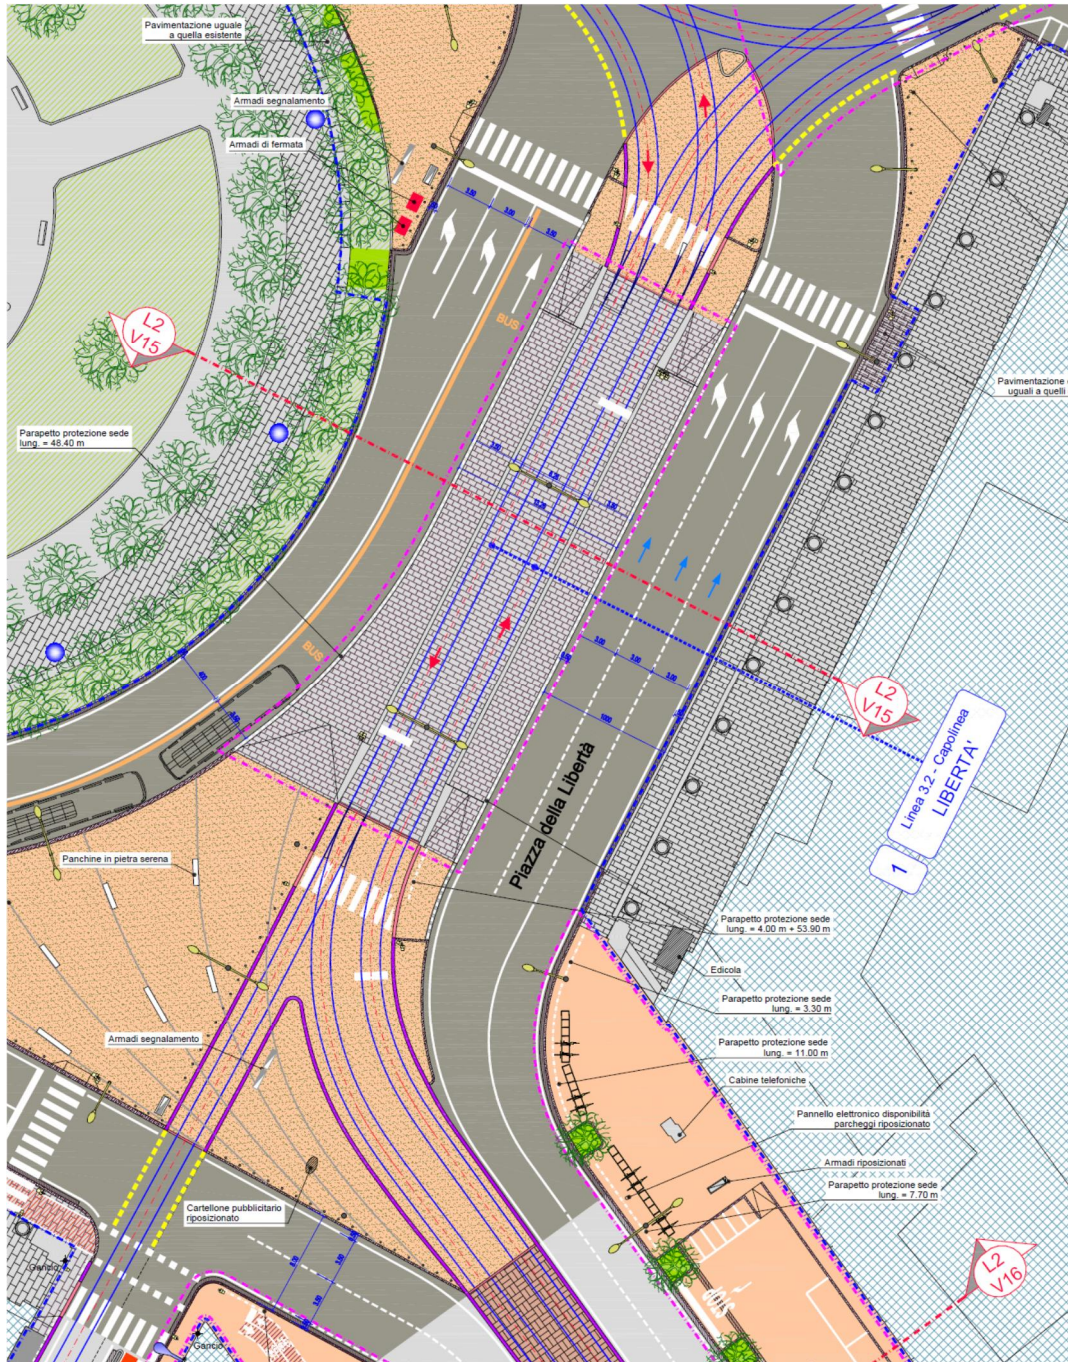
Stralcio planimetrico progetto della zona est della piazza
